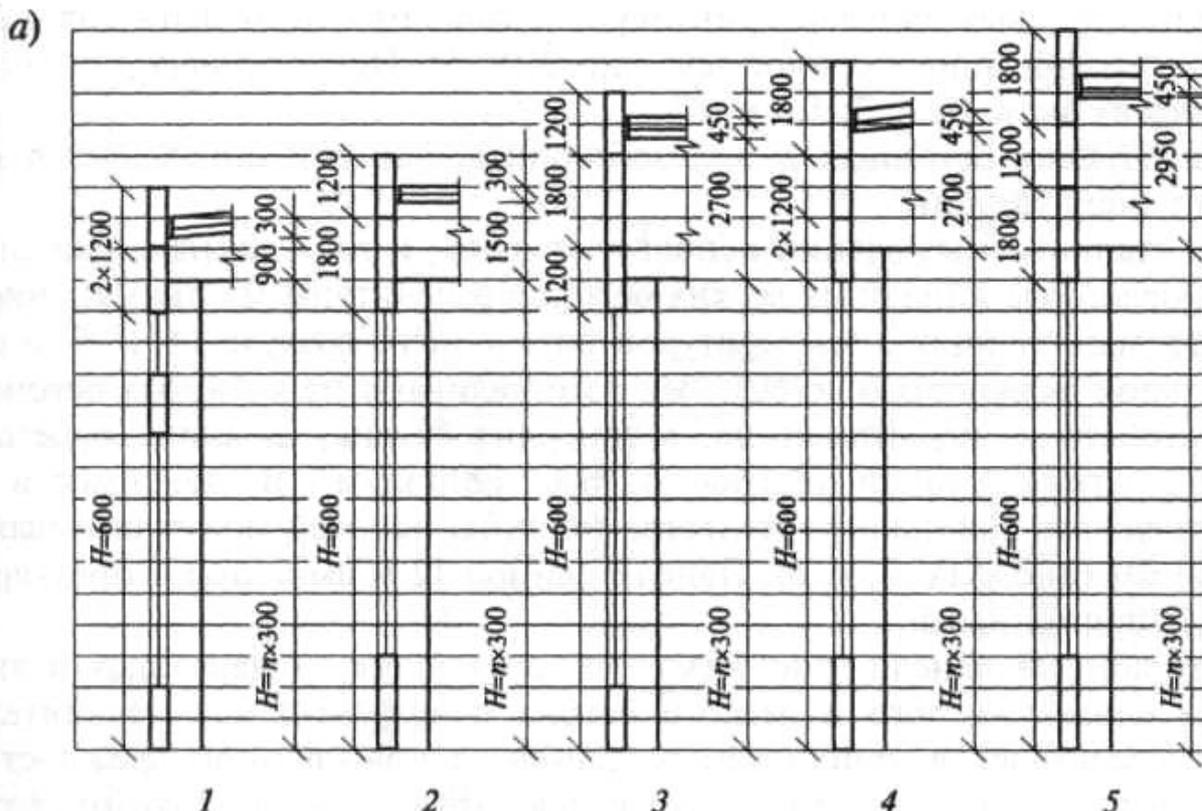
Схема раскладки панелей по условиям унификации в продольных стенах одноэтажных зданий: 1-3 – при железобетонных балках и фермах покрытия; 4-5 – при стальных фермах покрытия
